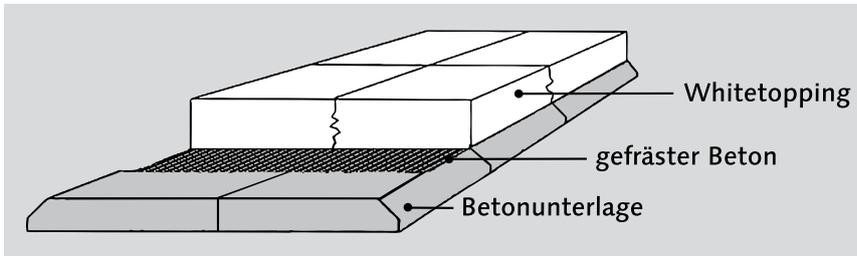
Systemskizze Whitetopping „Beton auf Beton“
